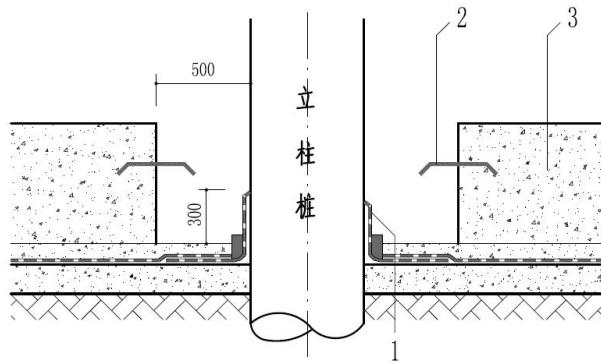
(a) 钢筋混凝土立柱与底板节点防水
